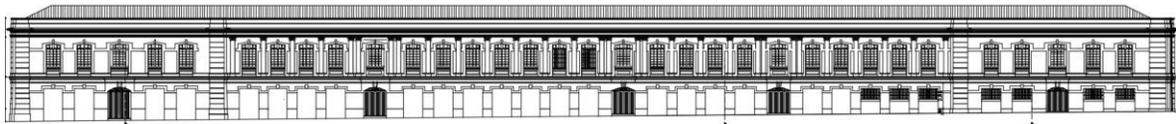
Fachadas calles 9 y 10 – FLAUTA
